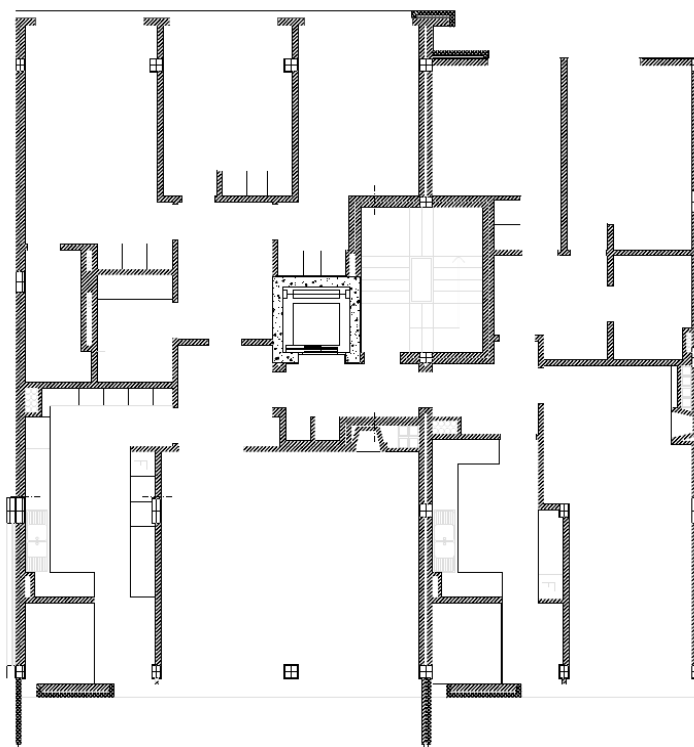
Planta e arquitectura dos Pisos 1 a 3.
